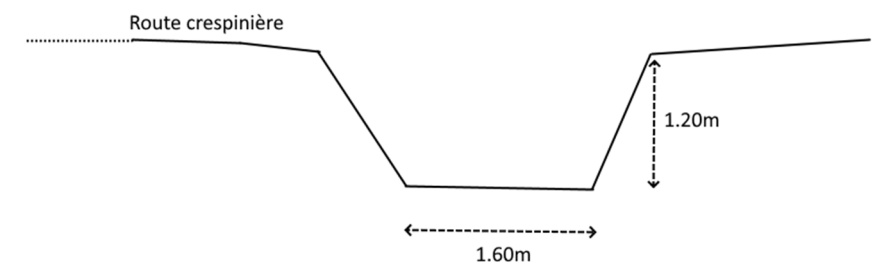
coupe du ruisseau en aval d'un busage - coupe B
